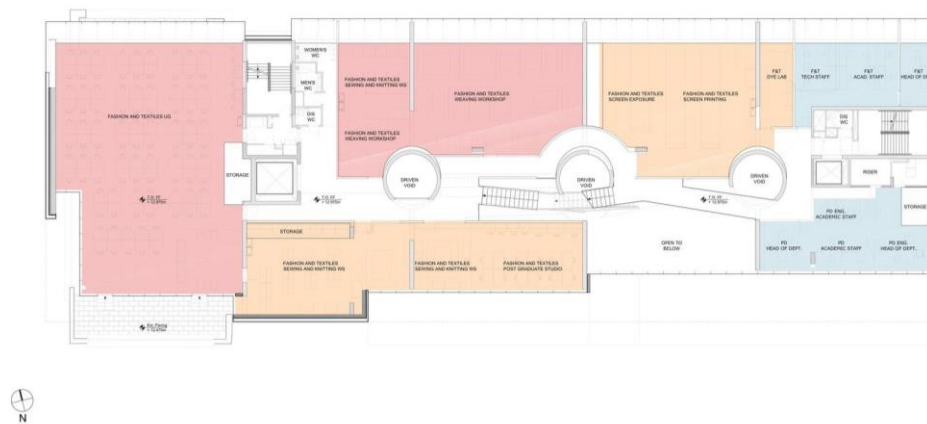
Planta Edificio Reid glasgow school, Fuente: Steven Holl architects
